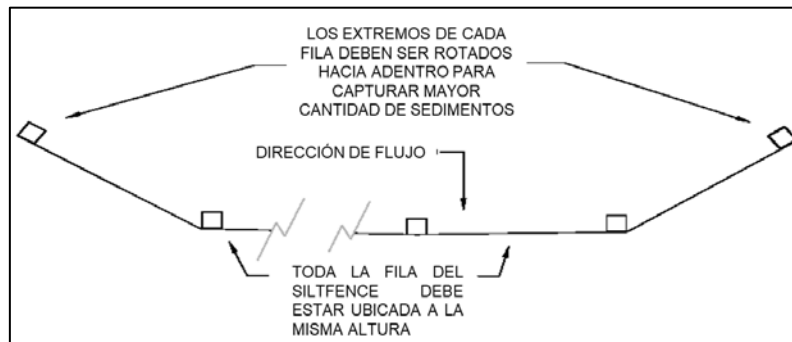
Diagrama vista en plano de colocación de silt fence con extremos rotados.
